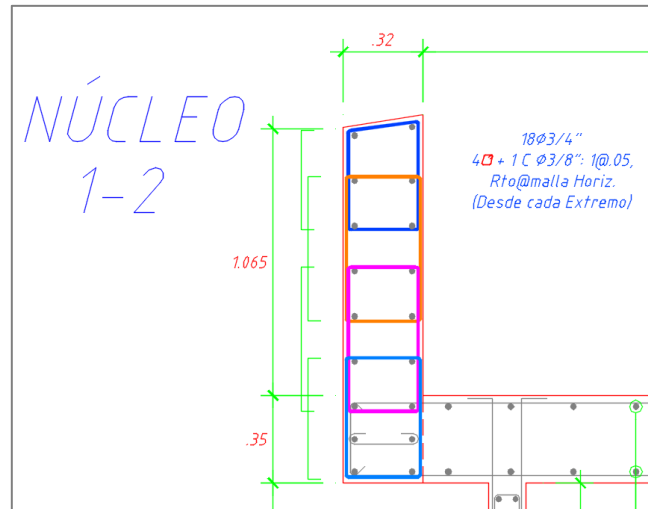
Obra: Edificio Art & U-Barranco - plano E-05 - Sección de Núcleo 1-2 de Placa PL-07. Fuente Ferralia Perú.
